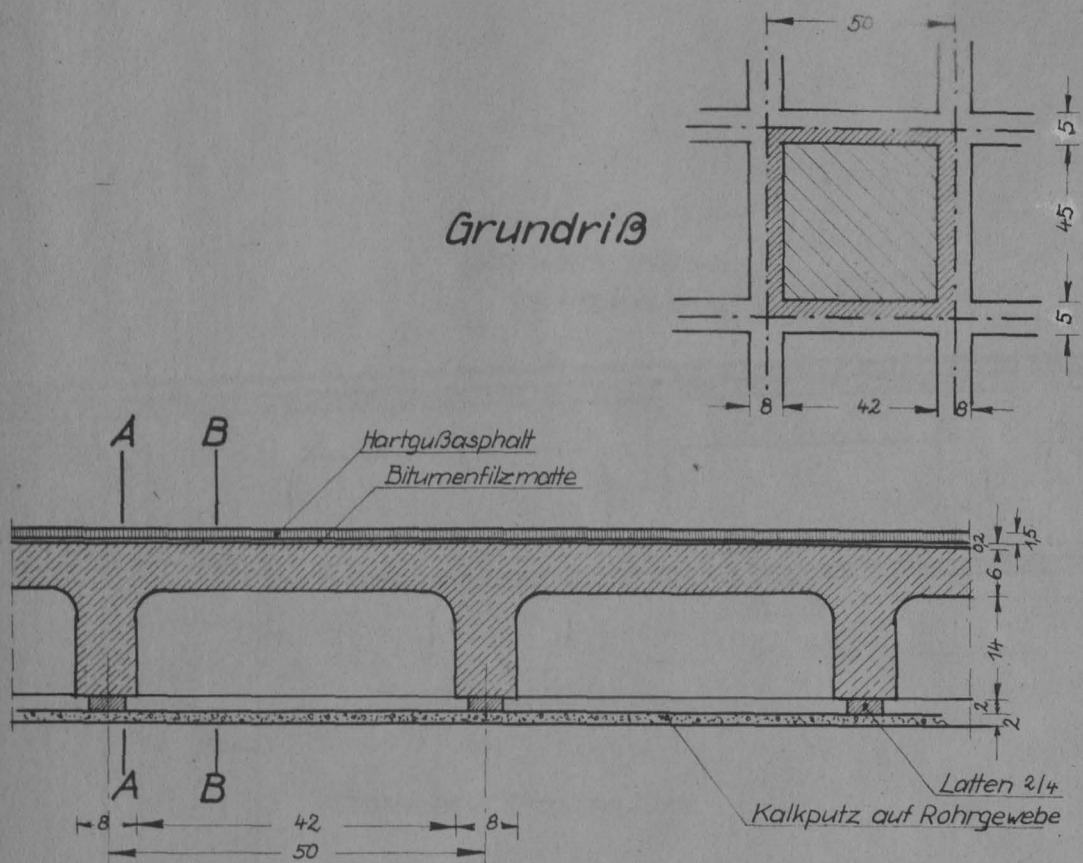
Querschnitt u. Grundriß durch die Wohnungstrenndecke (Typ A)
